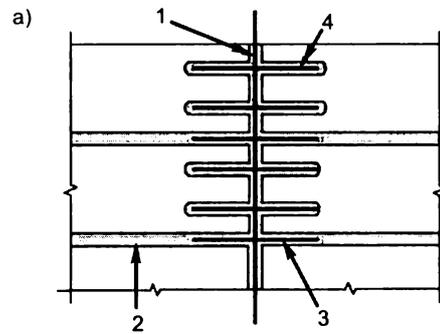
Узел примыкания плит пустотного настила к периметрической связи
